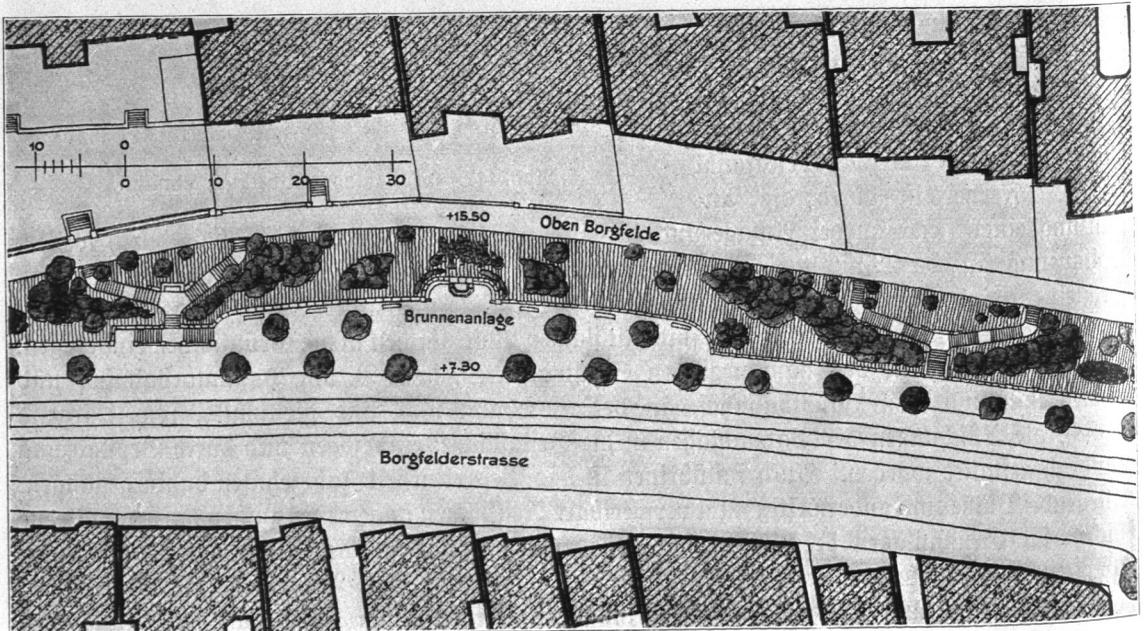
Anlage Borgfelder Straße, Grundriß.
